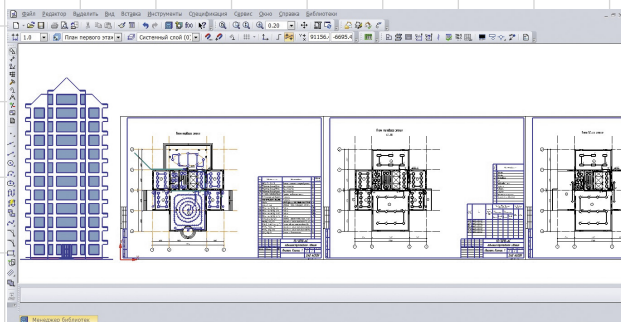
Планы многоэтажного здания с проектом электроснабжения
